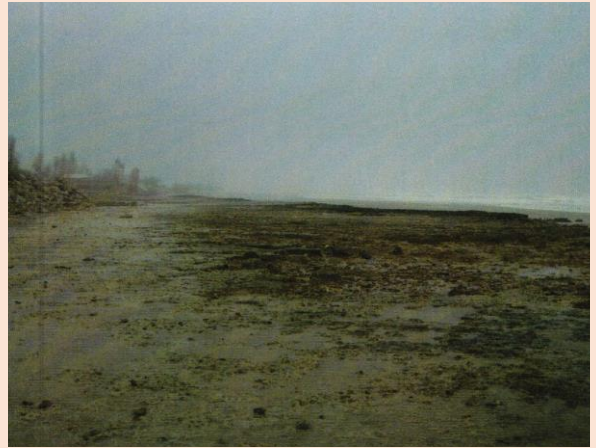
Muro de escolleras deteriorado en playa de Montijo
